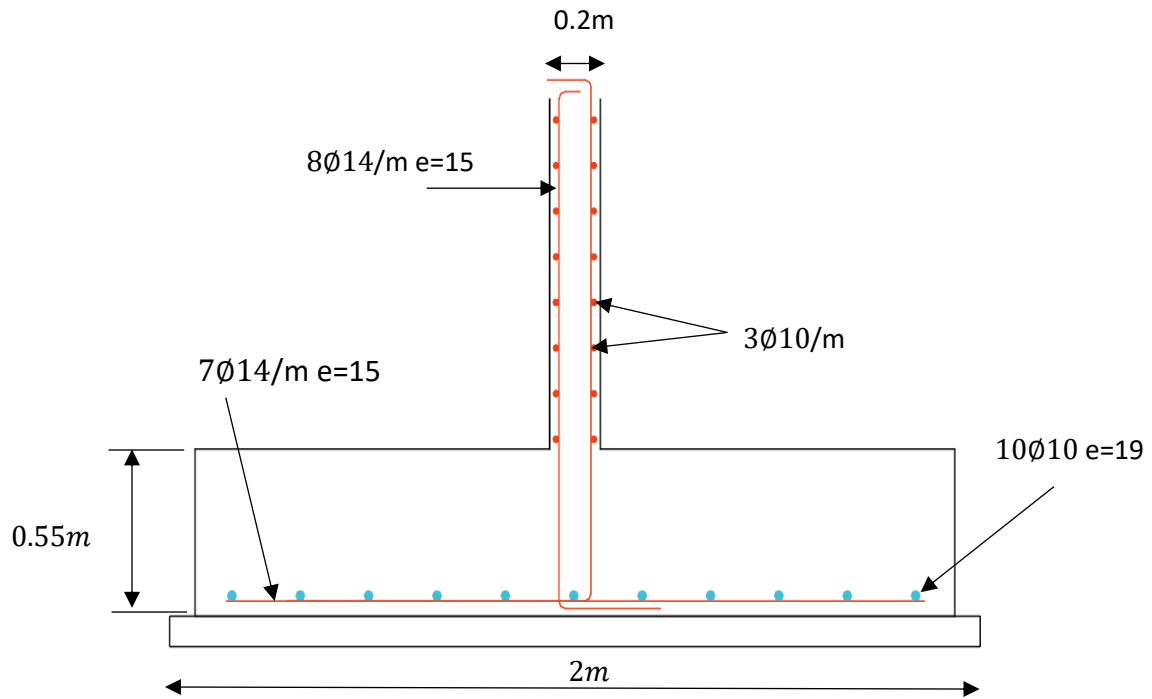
Ferrailage de la semelle filante sous voile périphérique
